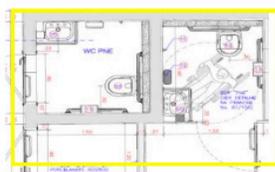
(inf): Detalhe Box acessível interno e externo.
